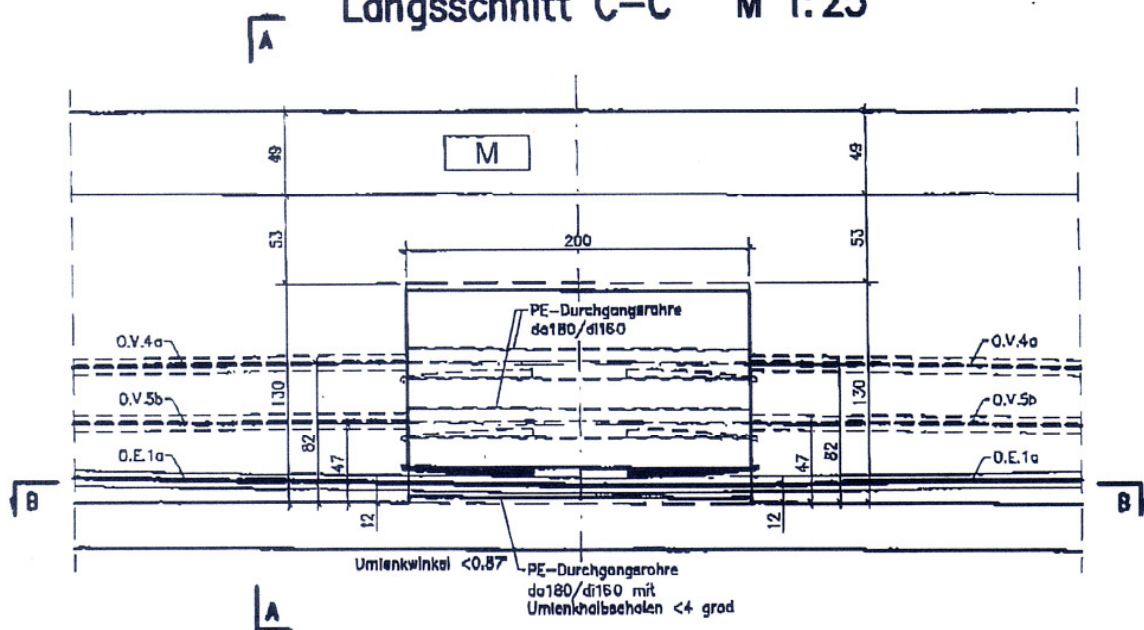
B.17 Längsschnitt Umlenkkonstruktion Flussbrücke
